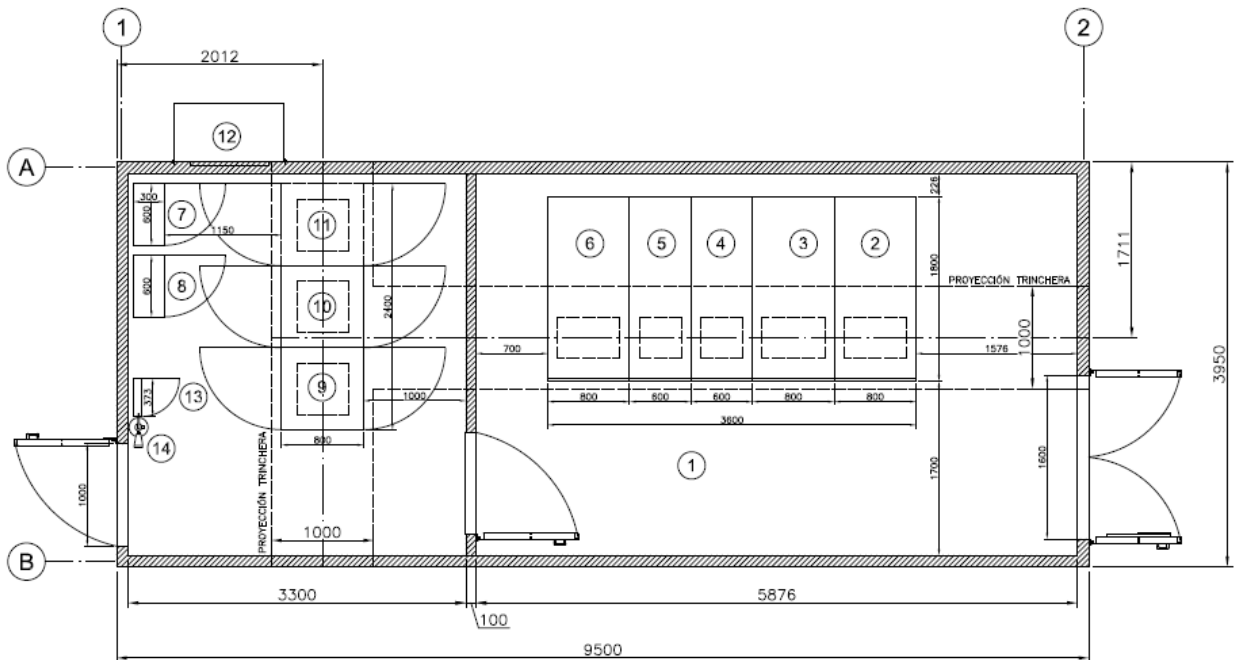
Sala eléctrica. Diseño base (solución en acero) – Planta de distribución.
